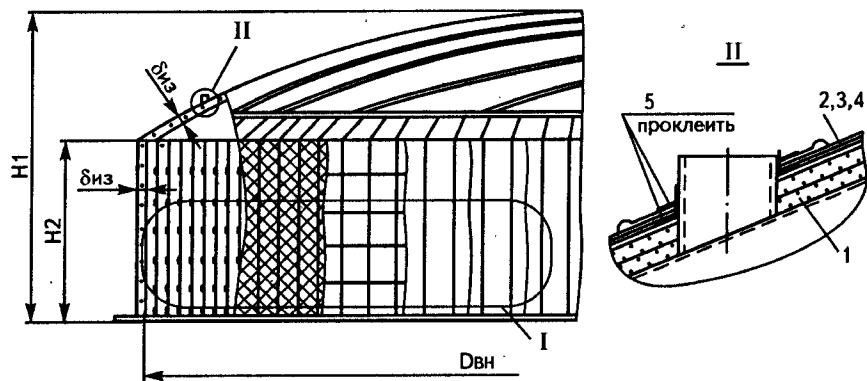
Конструкция тепловой изоляции на основе минераловатных плит для резервуара для хранения холодной воды: 1 – минераловатные плиты; 2 – пароизоляционный слой; 3 – предохранительный слой; 4 – защитное покрытие; 5 – герметизирующая пена
